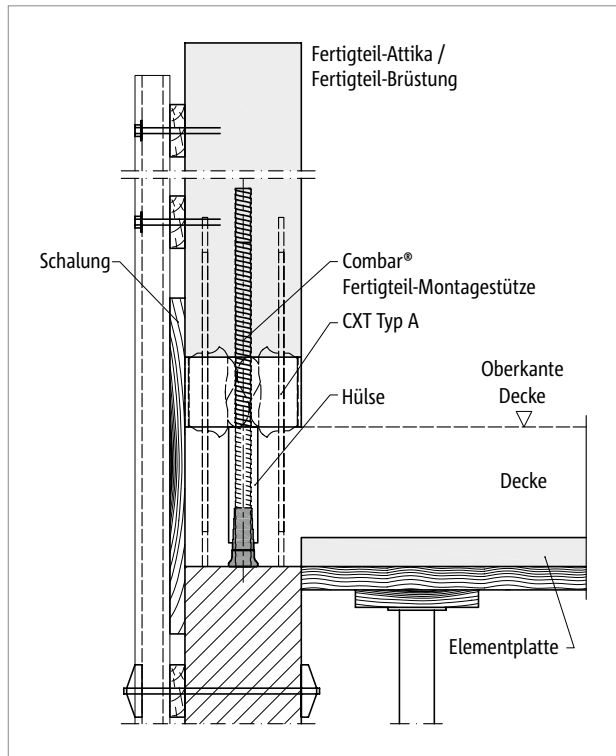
Schöck Combar® Fertigteil-Montagestütze: Einbau einer Fertigteilattika; Schnitt
